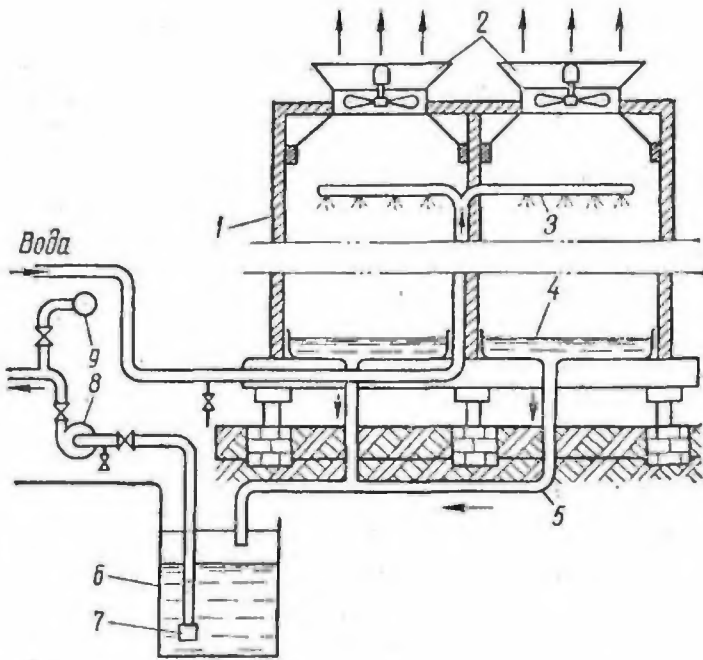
Схема монтажу вентиляторної градирні:
